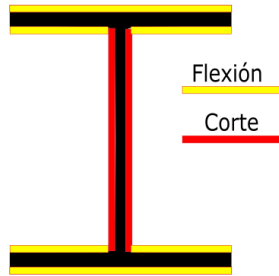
Esfuerzos en la soldadura Caso 01
